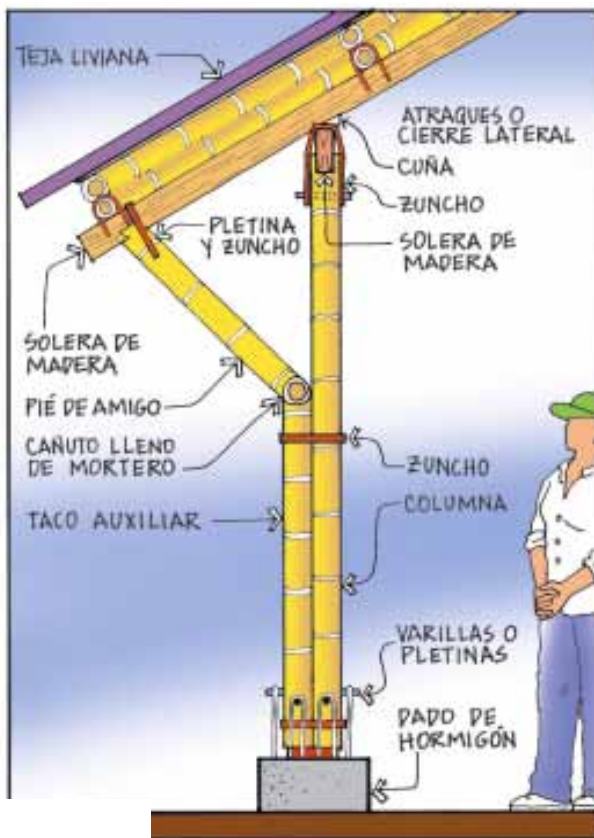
Détail de fixation chaînage périphérique/ poteau/plancher (Source : CO2 Bambu)
